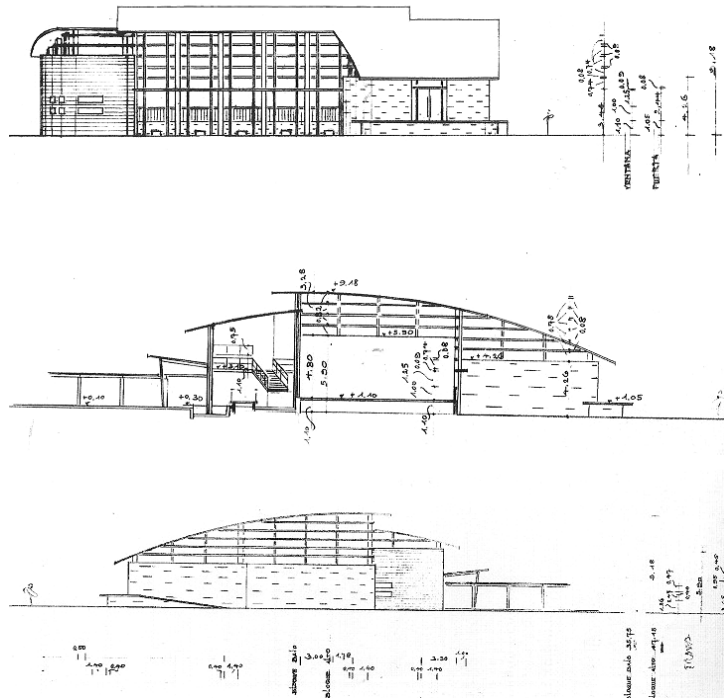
Hintere Fassade, Längsschnitt und West-Ansicht der Druckerei. Die dünnen Betonschalen des Daches beherrschen die Gestaltung.
